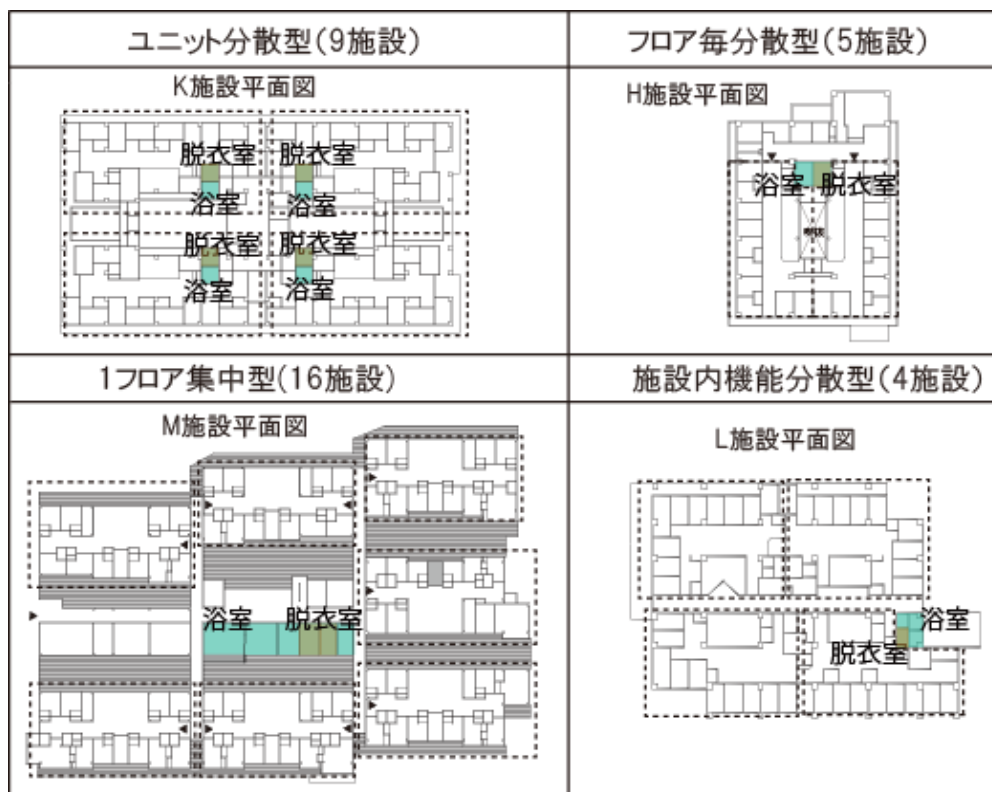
6. 1 浴室配置型と施設数および代表施設の平面図
